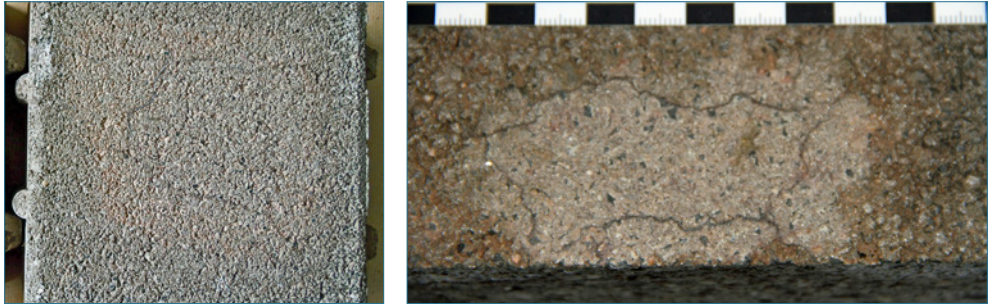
Wasserführende Risse in der Oberfläche des Vorsatzbetons von Betonpflastersteinen
